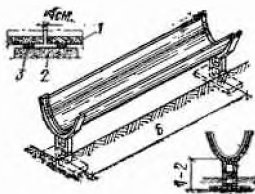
Железобетонный лоток криволинейного поперечного сечения
